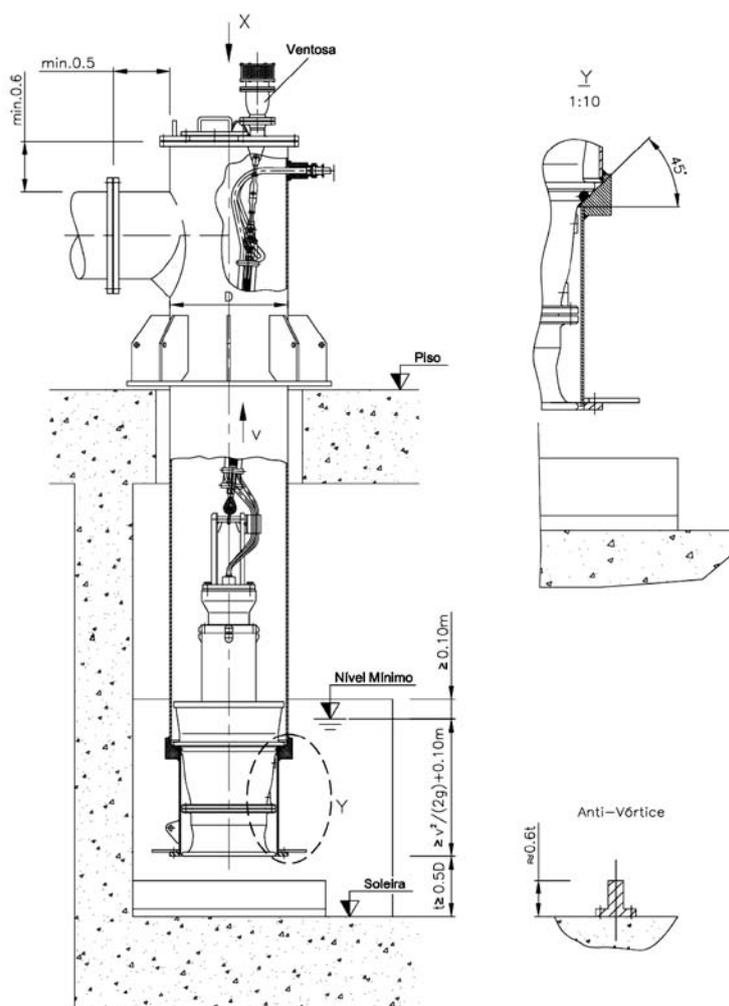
Grupo Submersível Apoiado em Coluna com Pormenor de Vedação (parte superior à direita)
